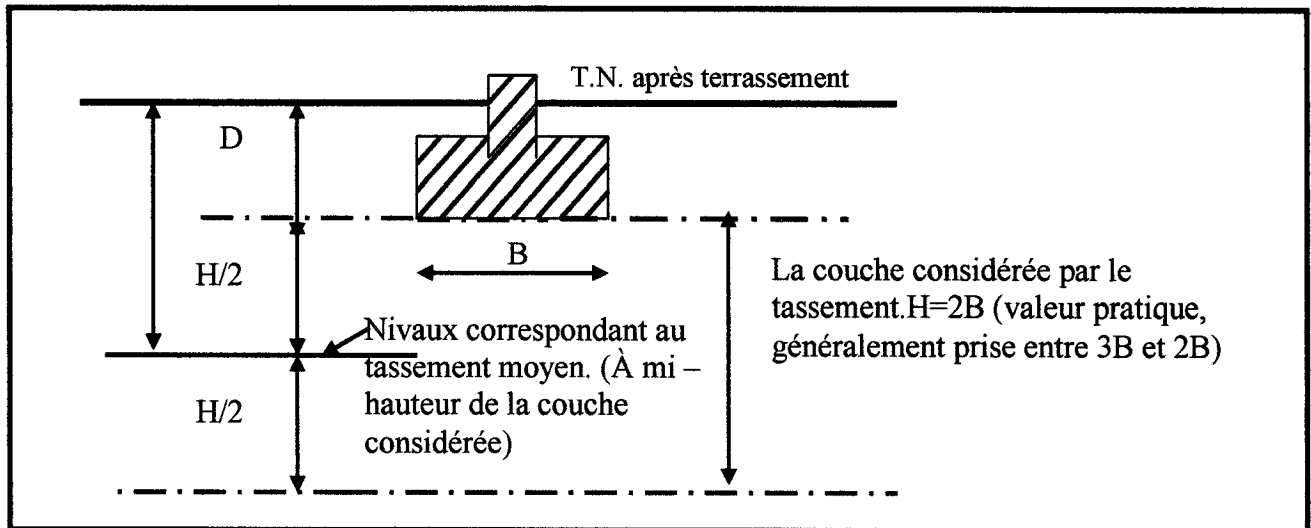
Tassement au dessous d'une fondation superficielle
